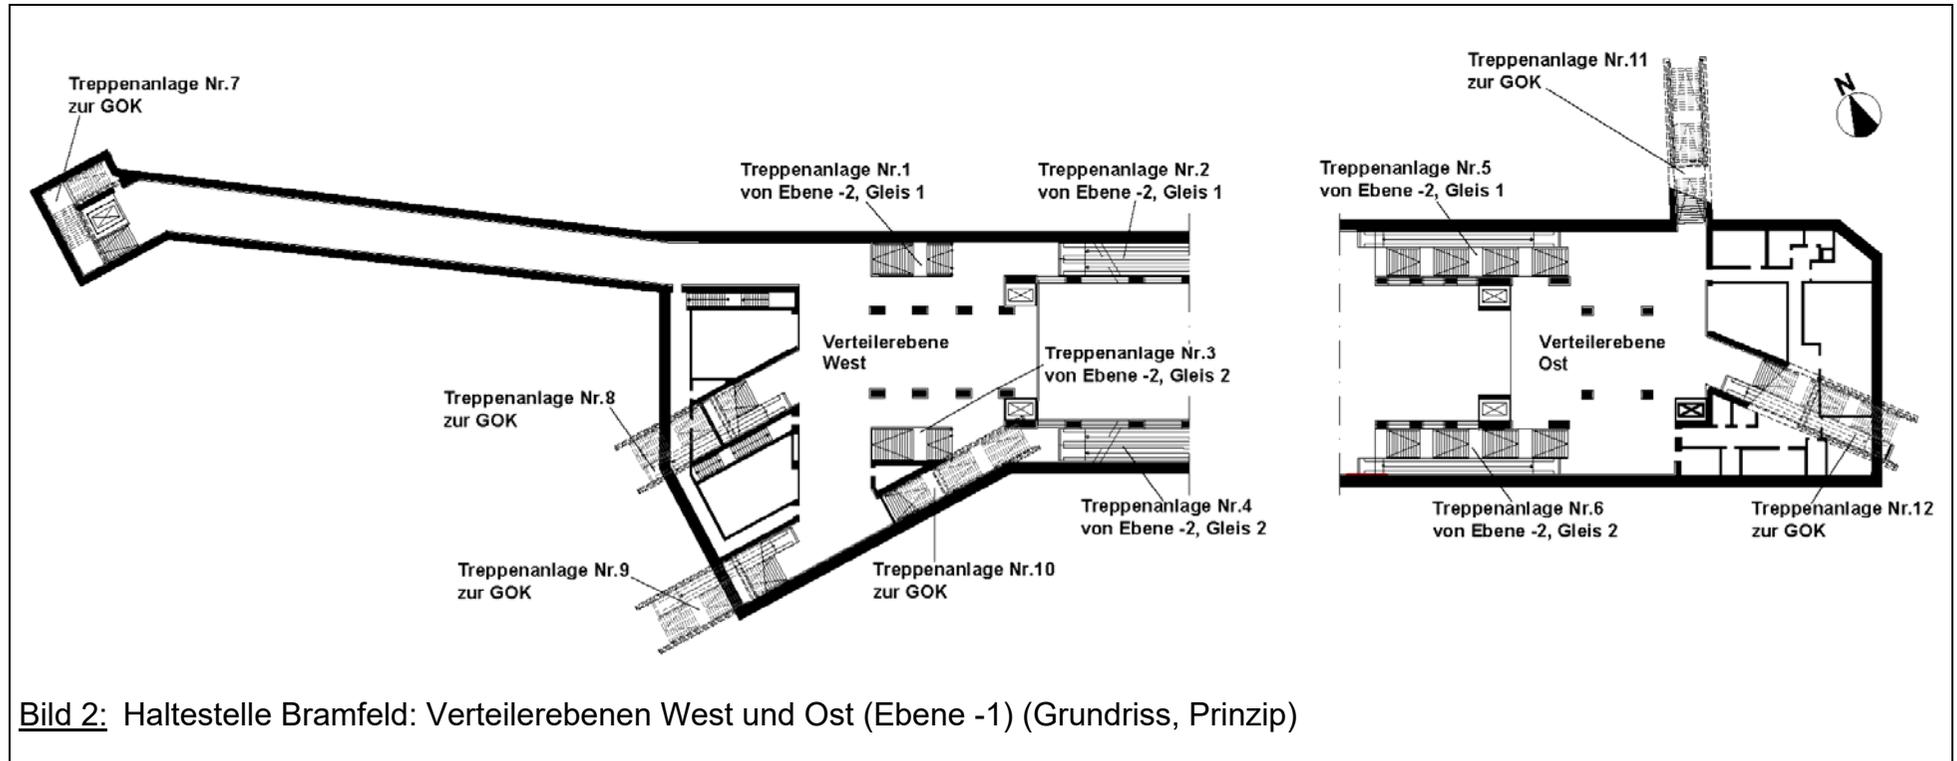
Haltestelle Bramfeld: Verteilerebenen West und Ost (Ebene -1) (Grundriss, Prinzip)
